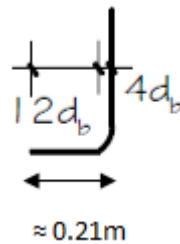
Longitud de anclaje de gancho entrante a losa de volado.
